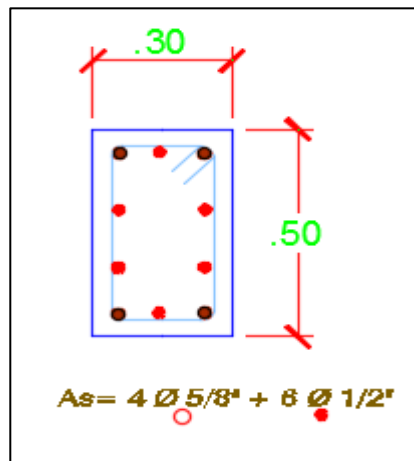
Sección Transversal Columna C-2 y-y. Fuente: Elaboración propia.
